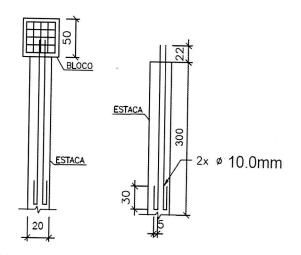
Proposta – execução de 04 novas sistema brocas / blocos.
